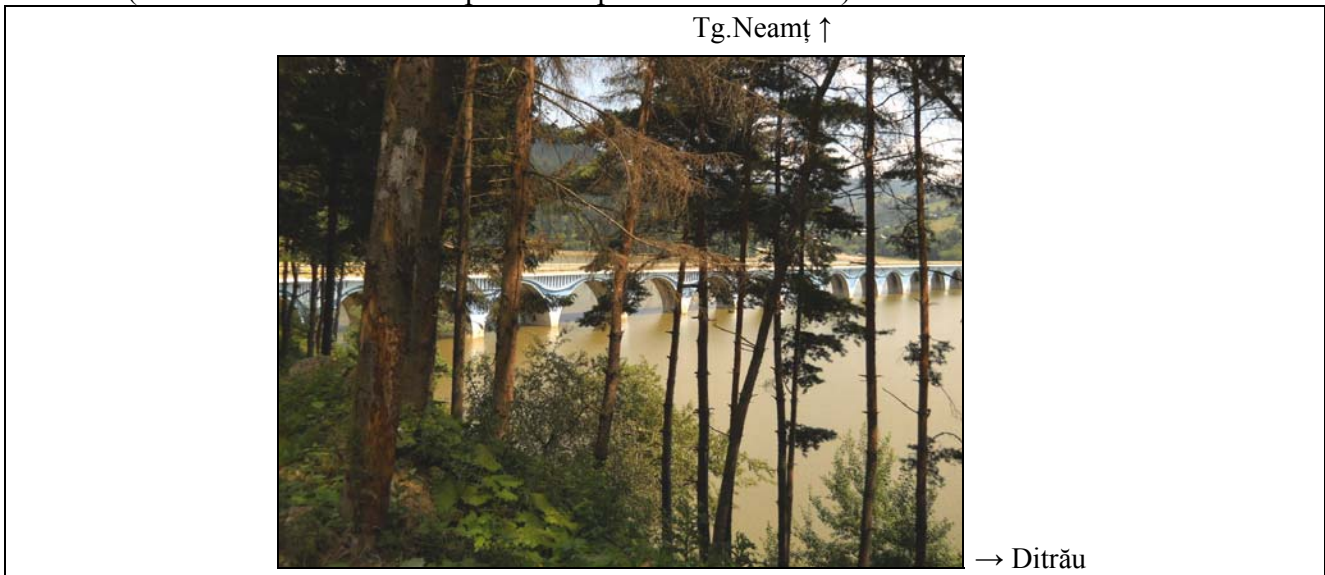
+ Foto 156: Panoramă (de la dreapta la stânga) – detaliu spre amonte traseu proiectat cu viaduct – din zona km 56+540 (locație foto – zona supratraversării peste viaductul existent pe traseul DN 15) spre km 55+870 (zona versantului stâng al lacului Bicz – începutul traversării cu viaductul proiectat)
